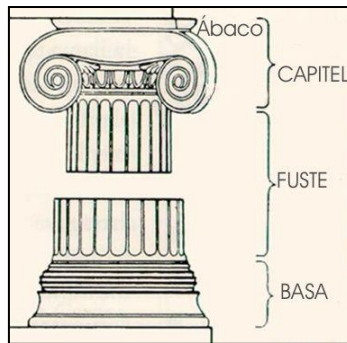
(Reproducciones de columnas piedra artificial, Columnas de piedra, 2020)
